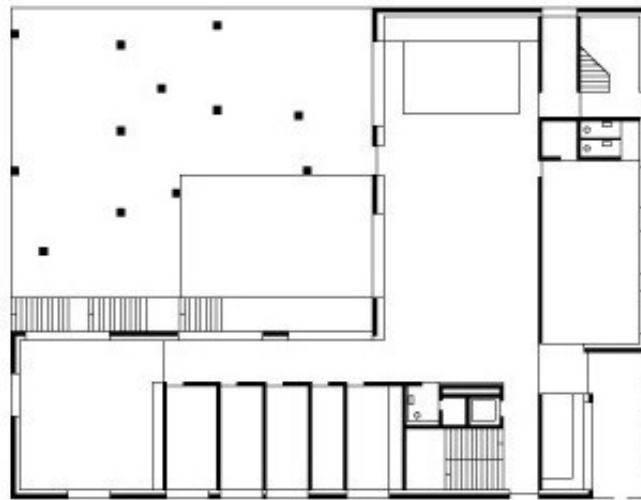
Planta baja, Centro de educación especial en Dornbirn.
